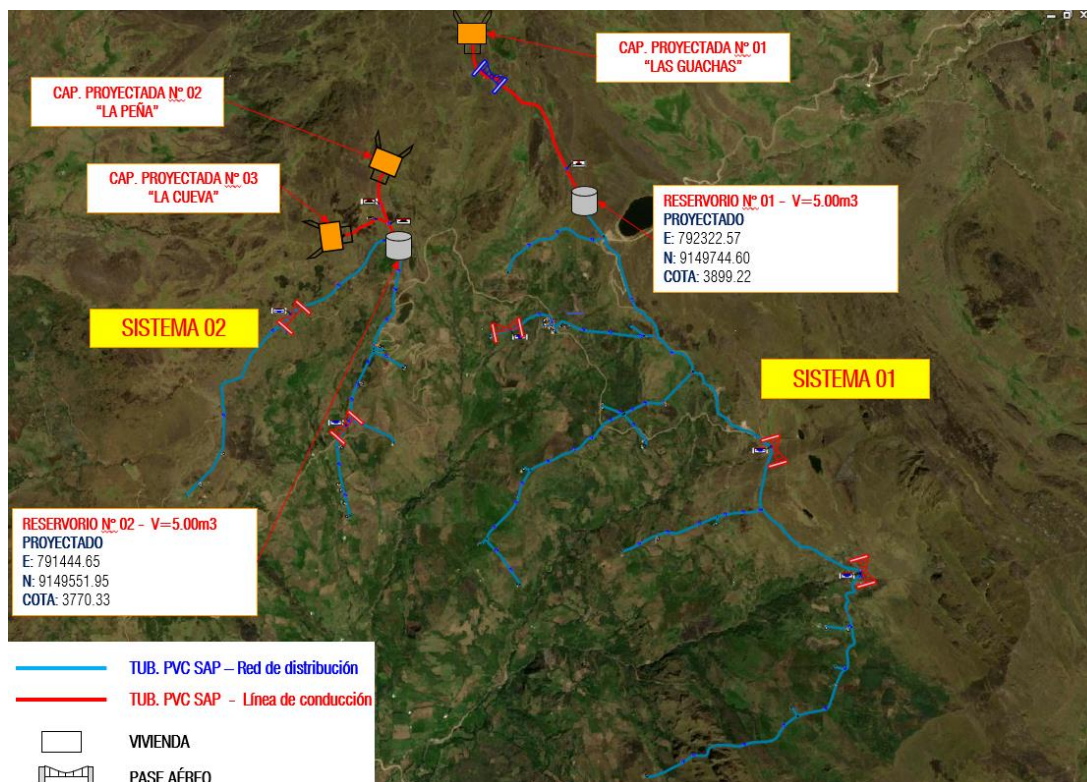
Croquis del planteamiento general proyectado del sistema de agua potable - Pampa de Llaro.
